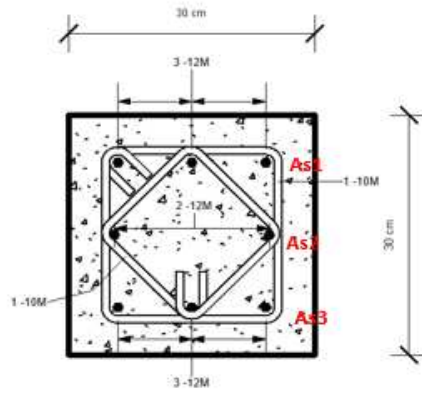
Armado de refuerzo de la columna (SMF) del sistema de 3 Pisos
